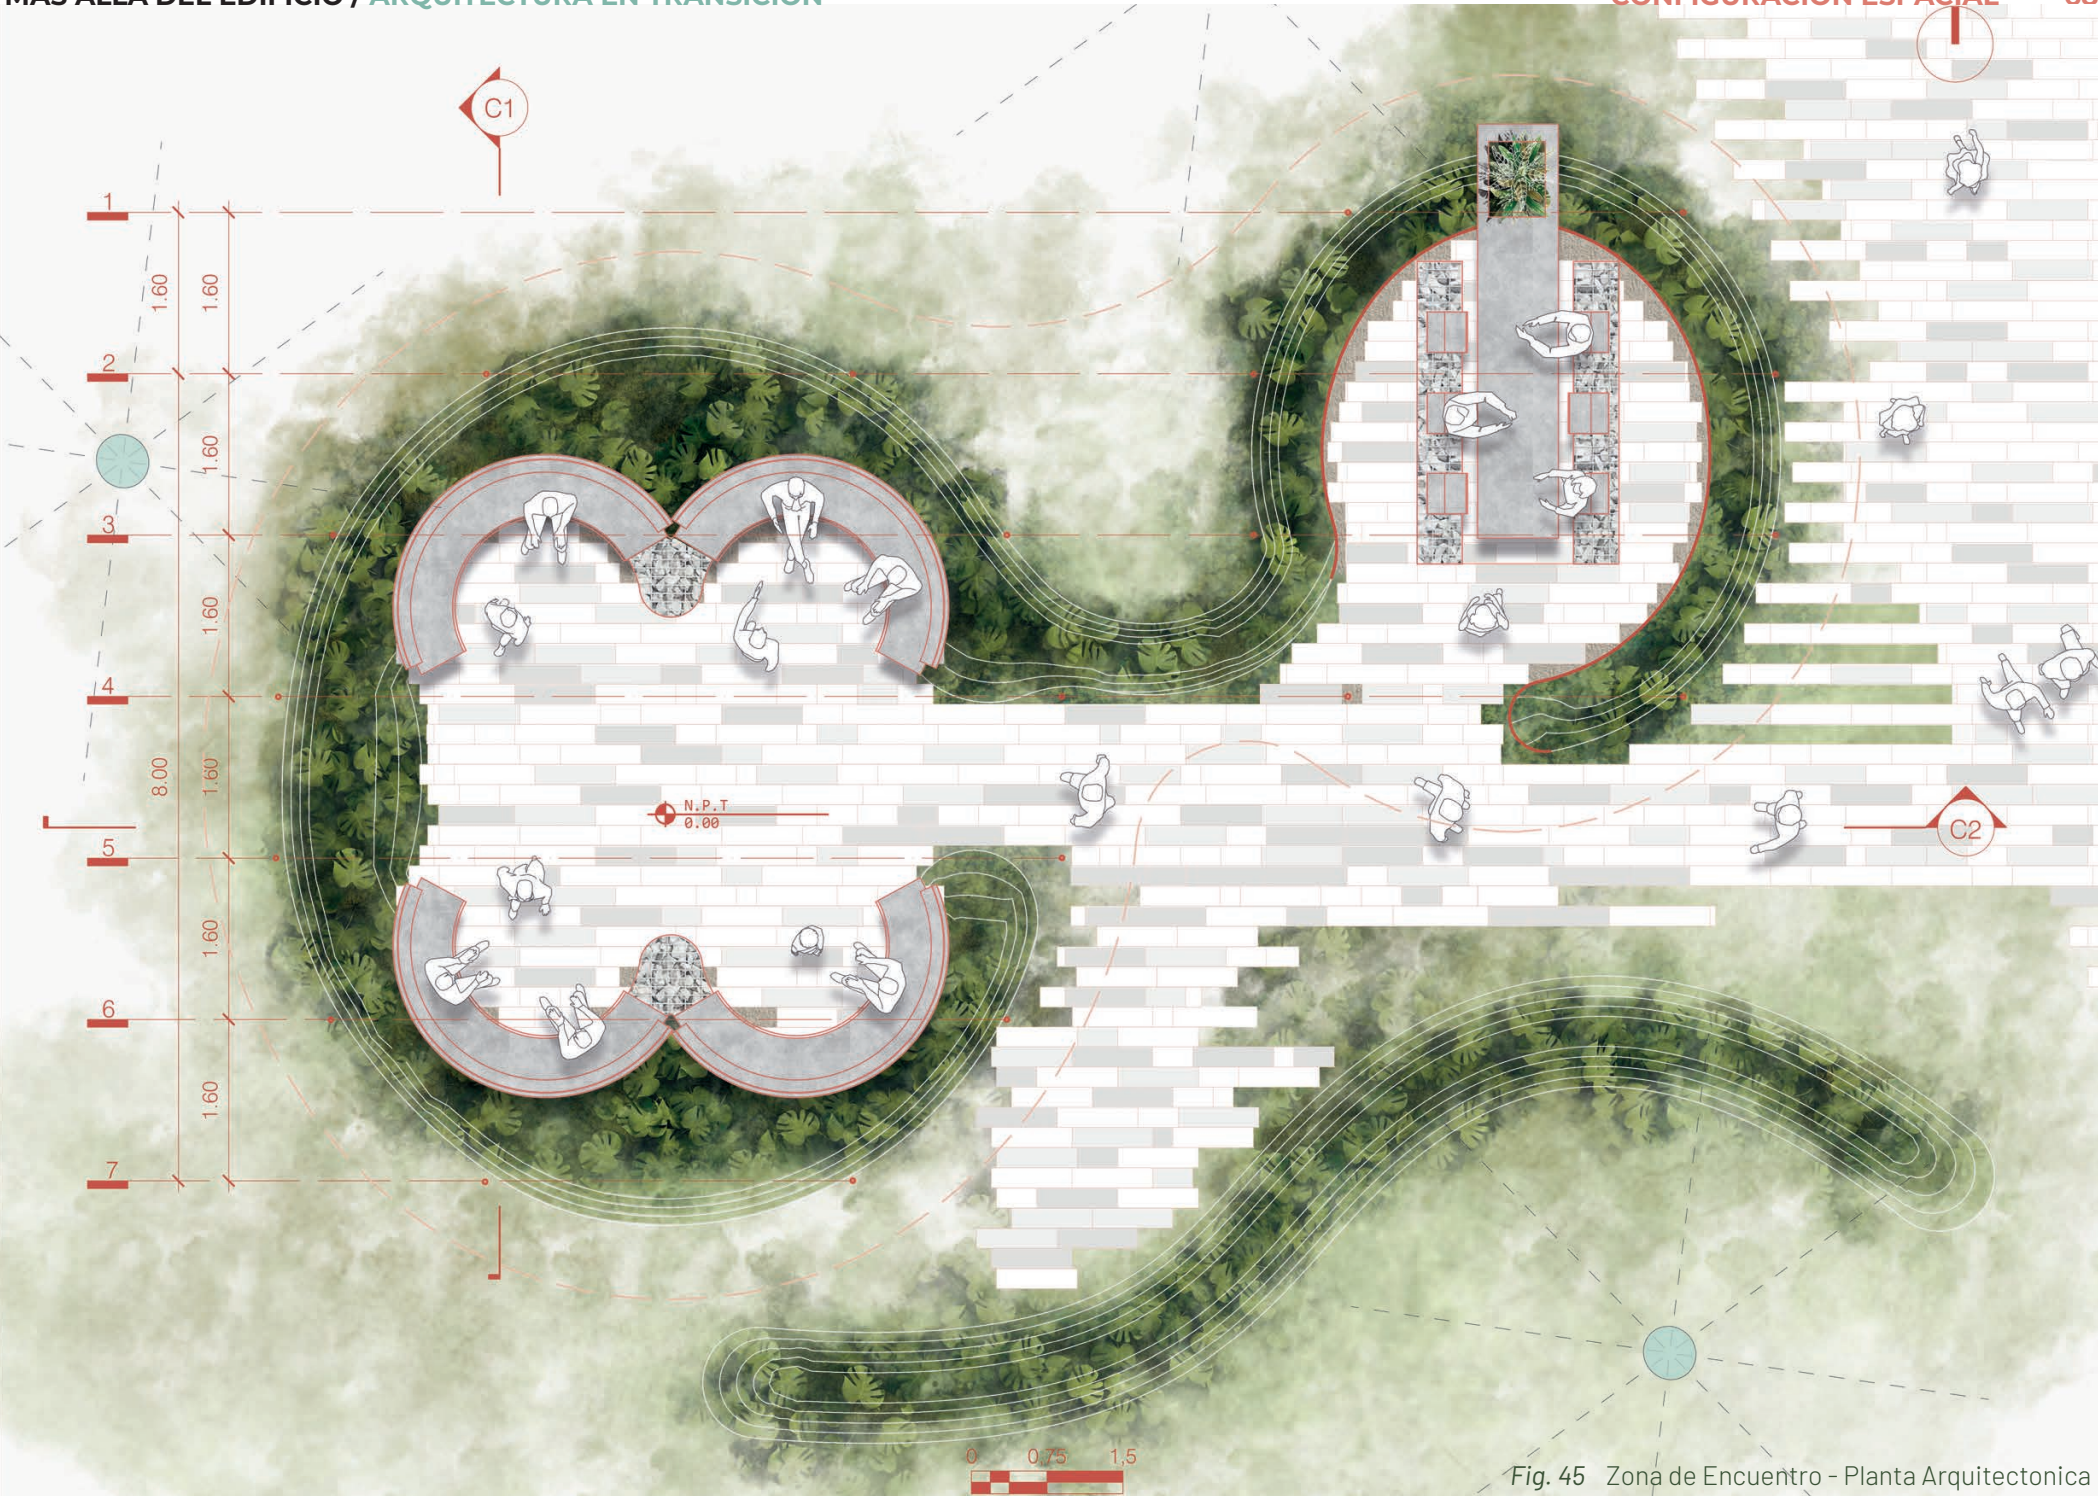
Zona de Encuentro - Planta Arquitectonica
